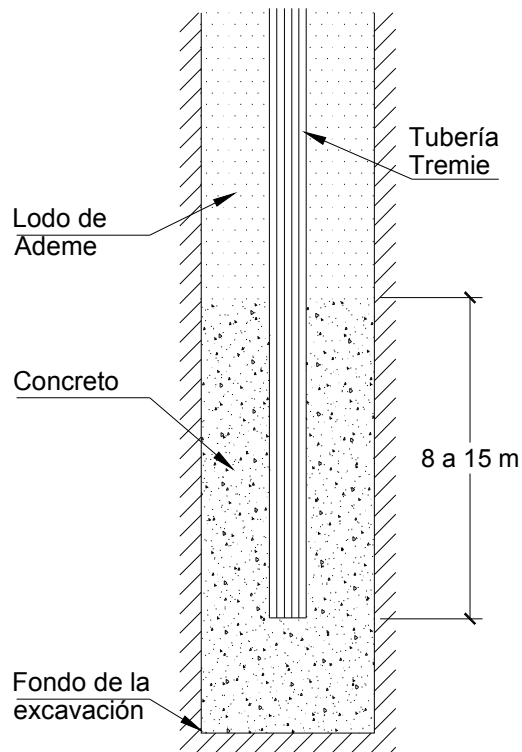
b. Distancia conveniente de tubería sumergida dentro del concreto, durante el colado.
